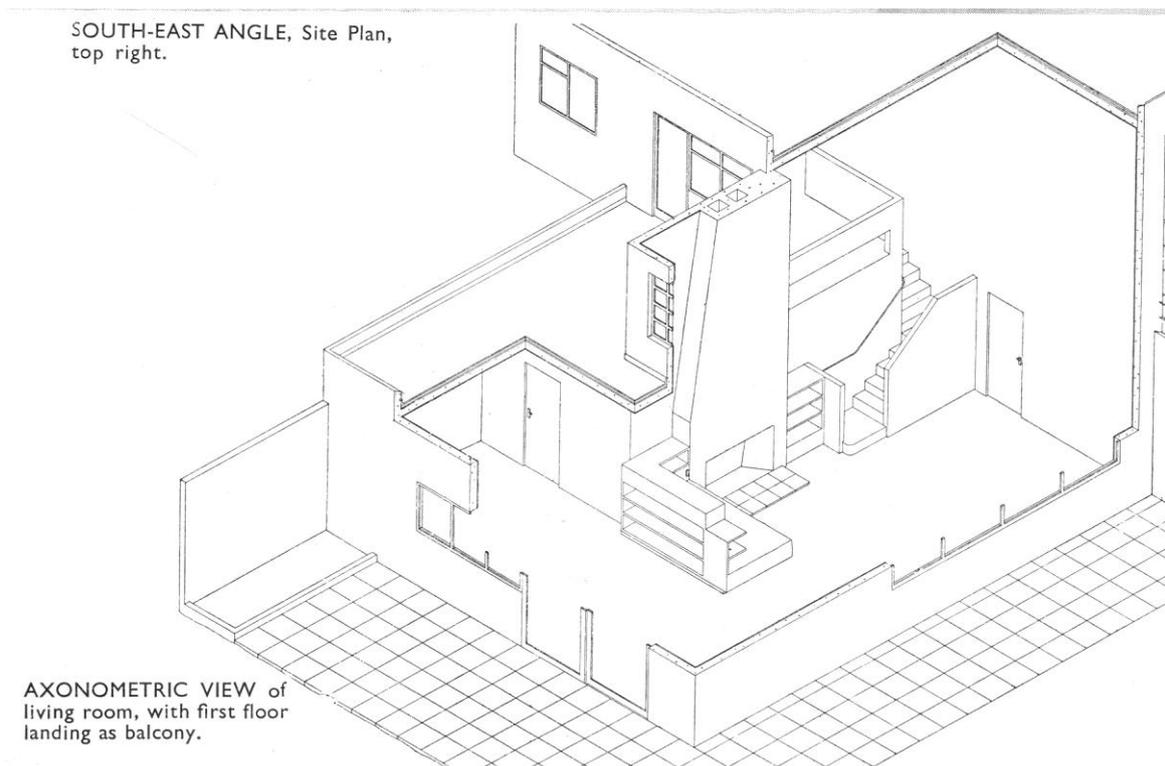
F.R.S. Yorke, Casa a Nast Hyde, Hatfield, 1935. Vista assonometrica dalla zona giorno. (da F.R.S. YORKE, *The Modern House*, The Architectural Press, London 1937, pag. 152).
